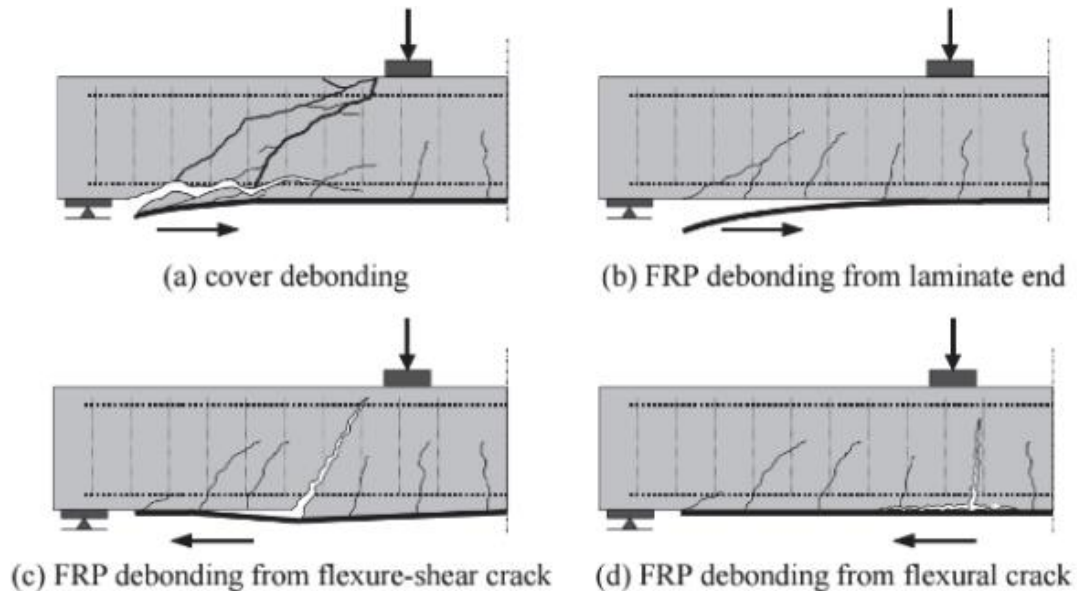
4 Différents problèmes rencontrés lors de renforcement des poutres en béton armé (site web).
